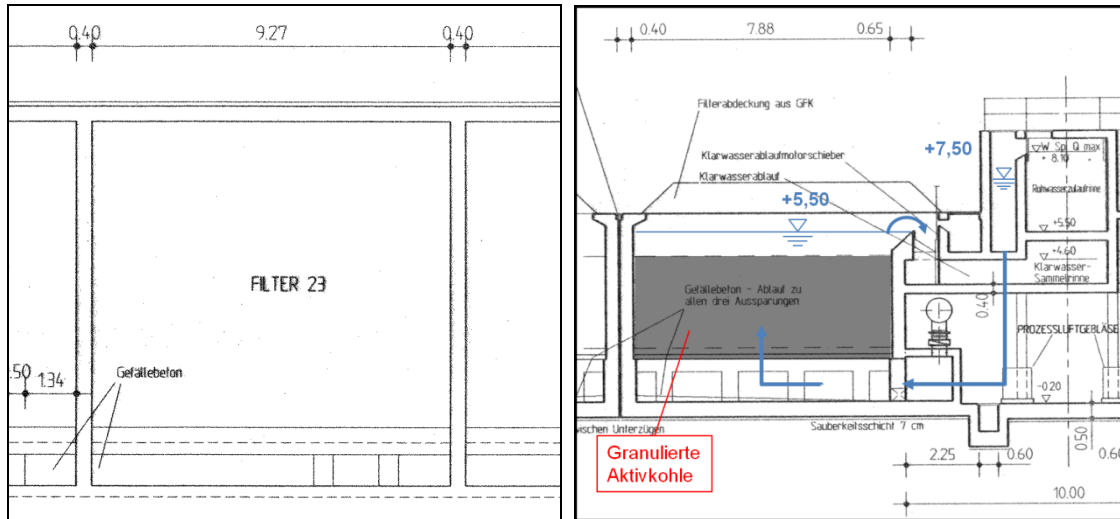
Schematischer Grundriss (links) und Längsschnitt (rechts) eines GAK-Filters
